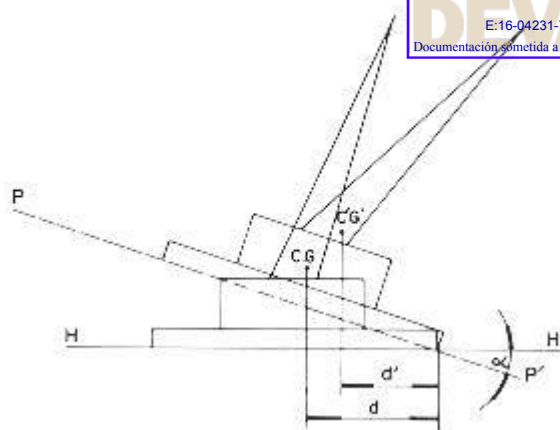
HH') Plano horizontal. PP') Plano de apoyo. a) ángulo entre ambos planos. CG) Centro de gravedad de la máquina. d) Distancia de la arista de trabajo a la vertical por CG.
